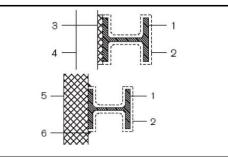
Montage contre la façade ou un élément de construction avec résistance au feu: variantes pour poteaux (s'applique par analogie aux poutres)
